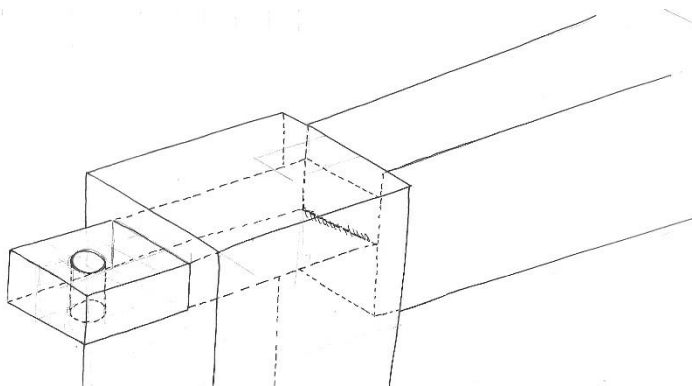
Aplicação do sistema de furo e respiga com cunha à estrutura de madeira _ Fonte: ilustração da autora
